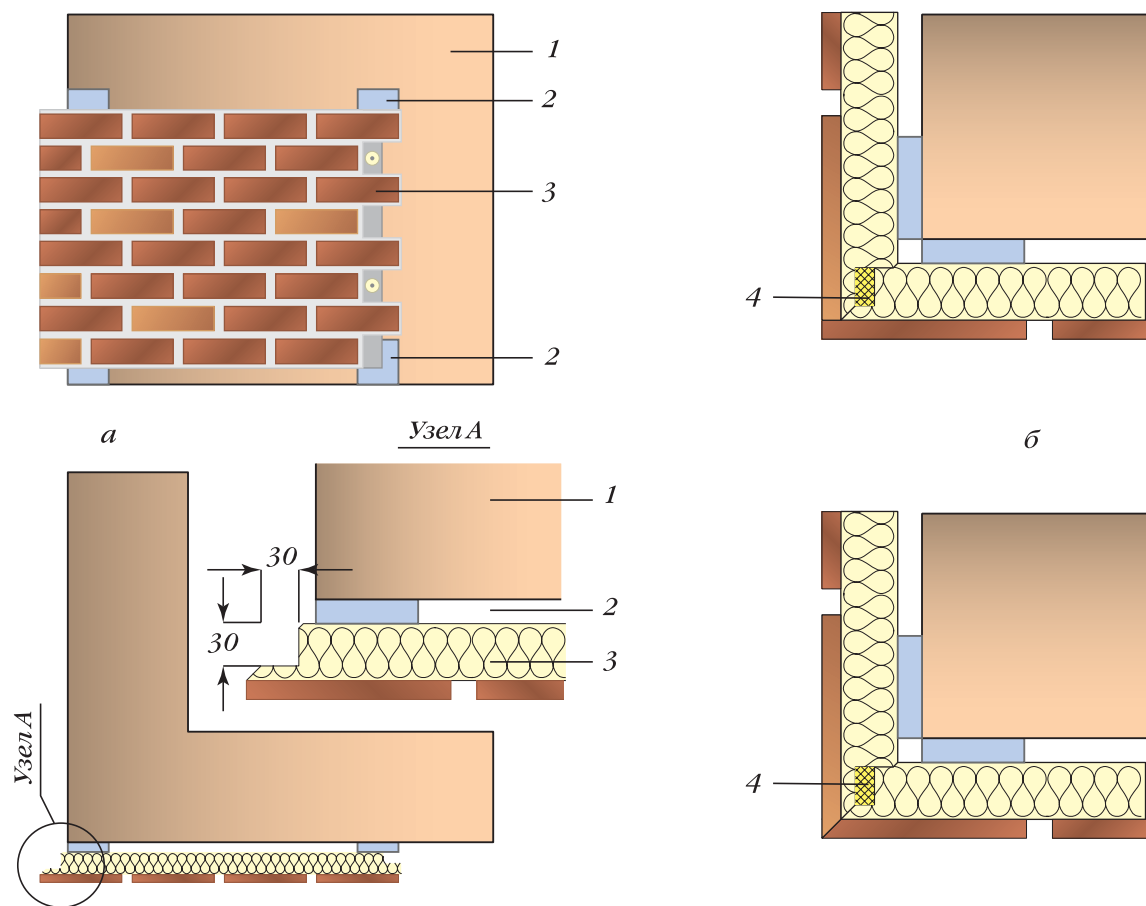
Установка угловых панелей (размеры в мм): а – монтаж первой панели; б – варианты соединений «в стык» и «на ус»; 1 – стена; 2 – вертикальные маяки; 3 – термopанель; 4 – валик из монтажной пены
